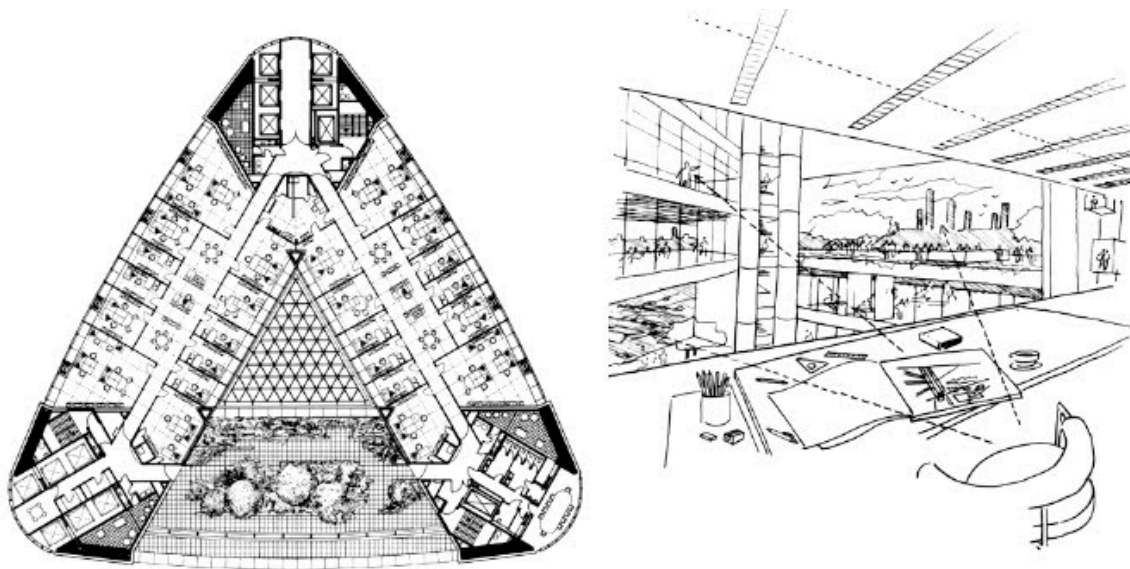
Commerzbank Tower*, em Frankfurt
